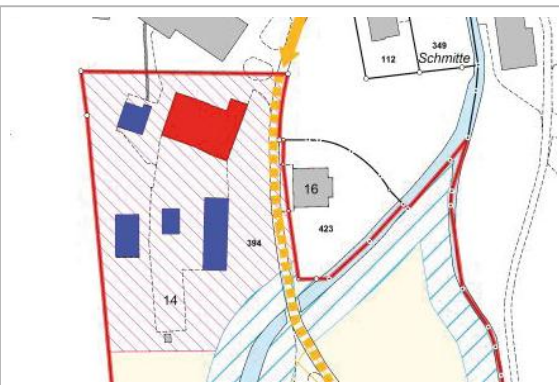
Bebauungsplan neu, Herrenhaus ausserhalb Bebauungsplan.
